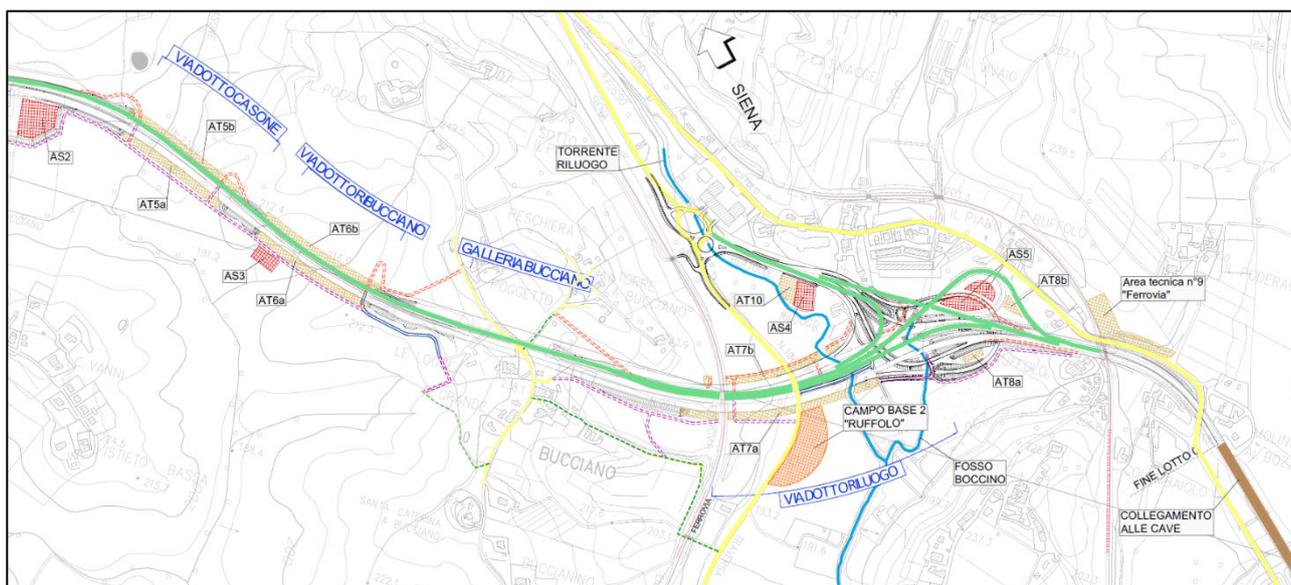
Localizzazione aree di cantiere – lato Svincolo Ruffolo
